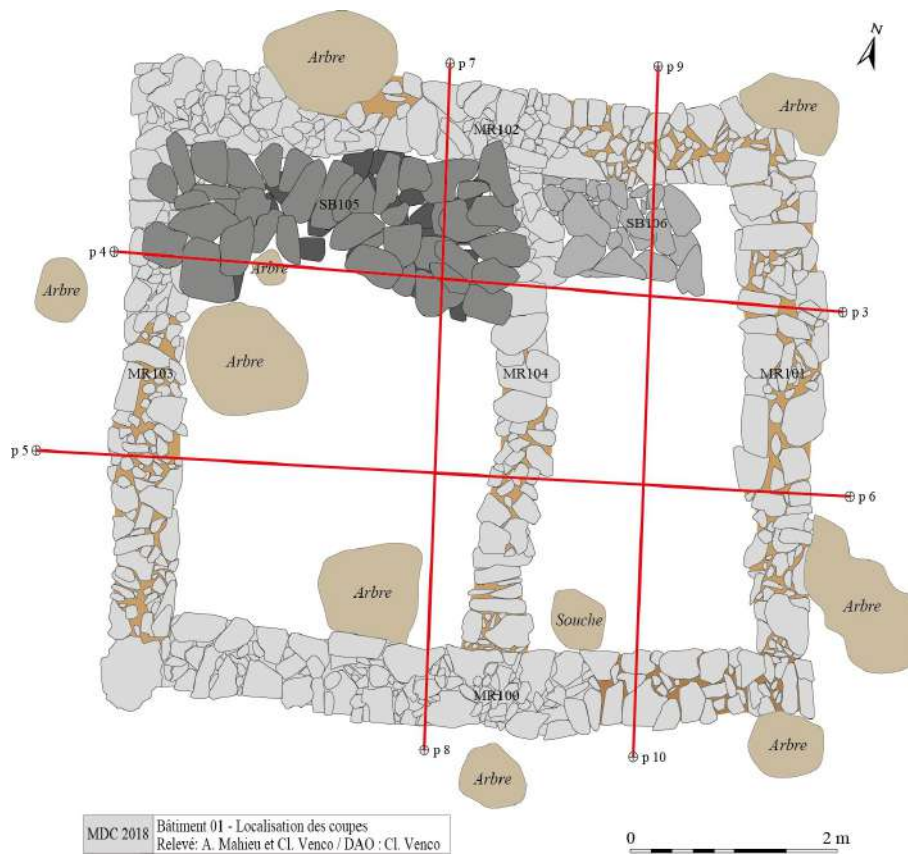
Bâtiment 01 – Plan d'implantation des coupes
